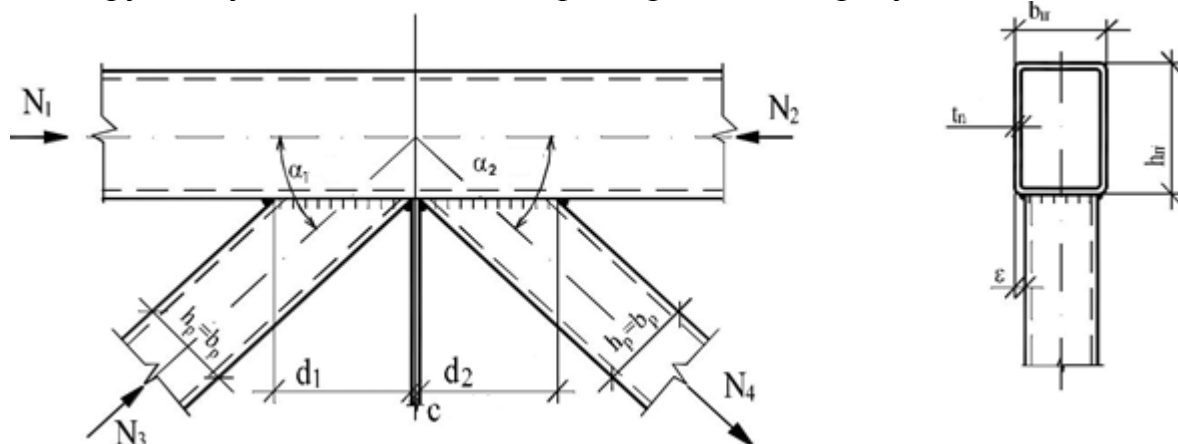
К расчету бесфасоночного узла стропильной фермы
